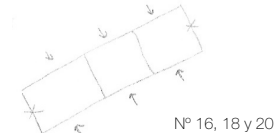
Bocetos en planta de la disposición de las construcciones situadas en la Rúa Moaña-Coia, nº 16, 18 y 20 (autoría propia).
